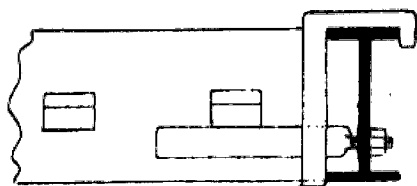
Assemblage de chevêtre en bois avec la solive en fer.
